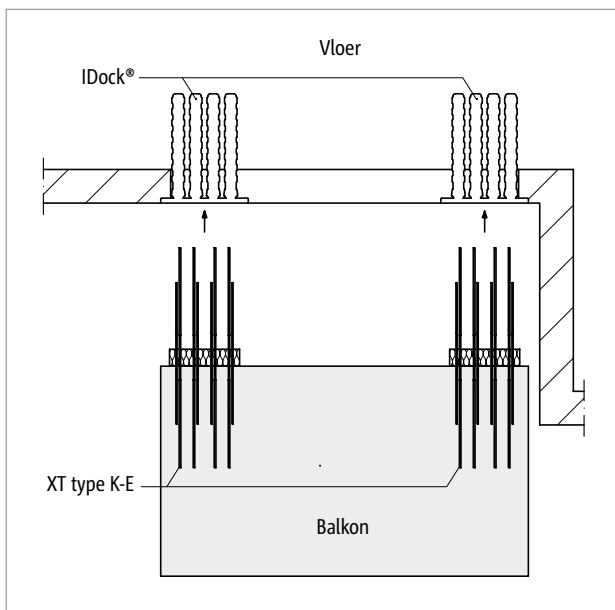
Schöck IDock®: Aansluiting uitkragend balkon, hier met Isokorf® XT type K-E en IDock2
